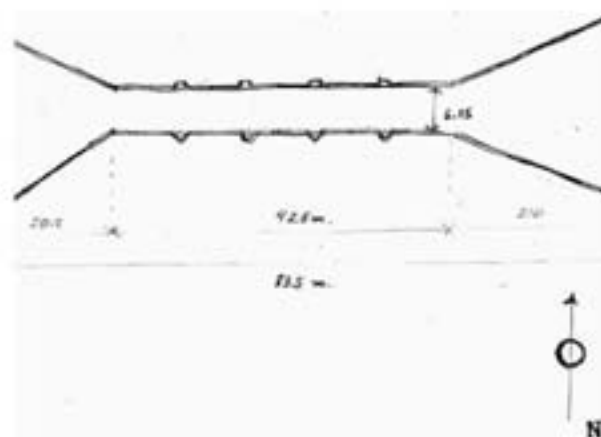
Planta del puente desde el lado sur. Dibujo: G. Boils.
